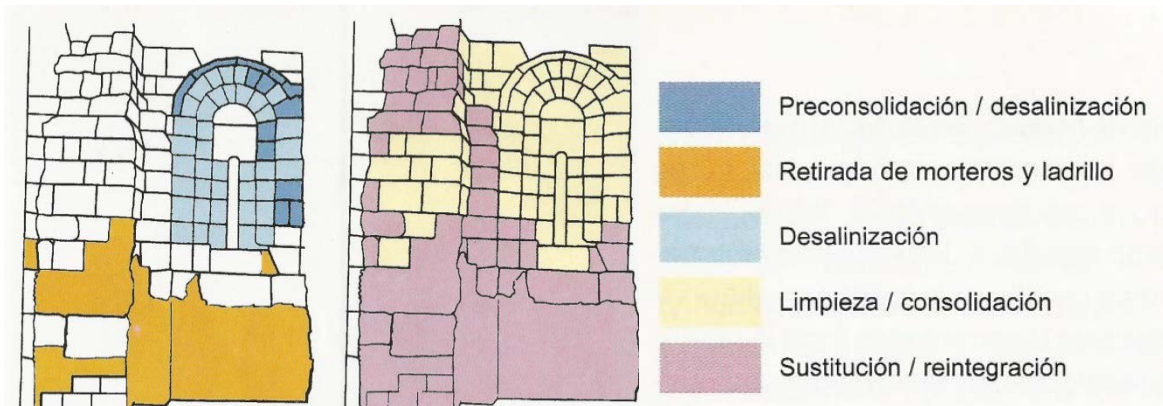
Iglesia de San Juan, planta estado previo y posterior.
